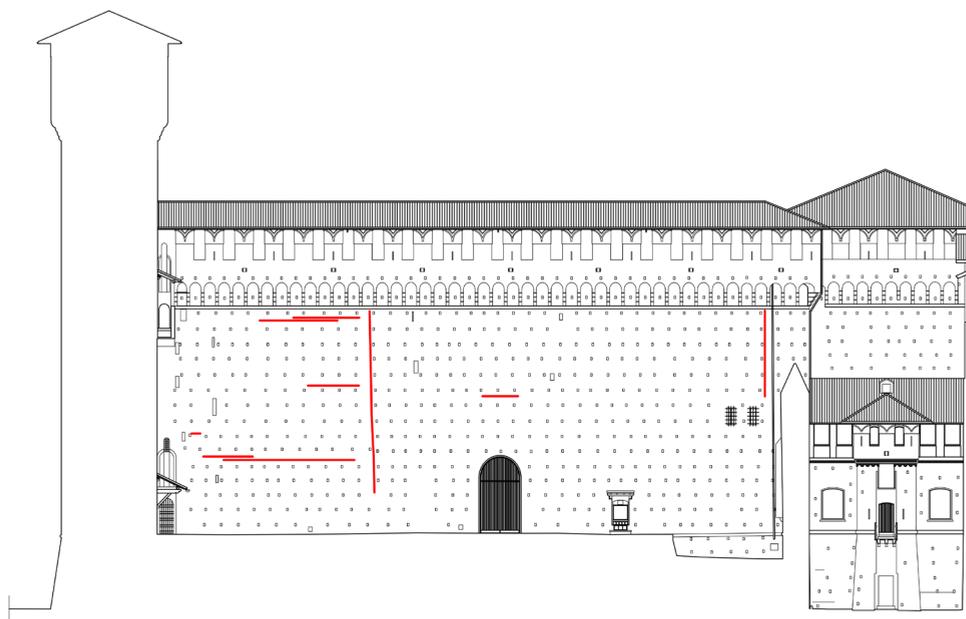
Fronte della Rocchetta verso la Corte ducale (rilievo ed elaborazione dell'autore)
